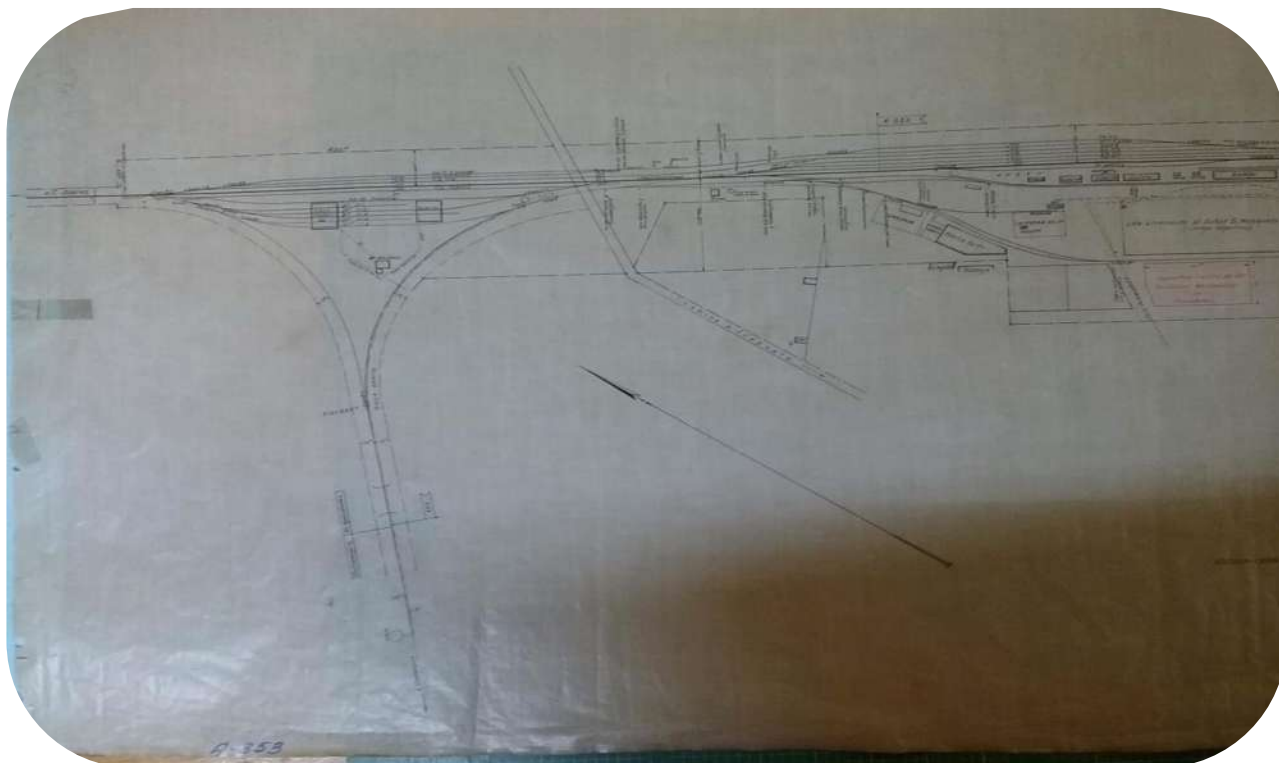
y 104: Plano para construcción de oficina del maestro mecánico. Febrero de 1910. Planoteca-Cedif (19/05/2019)
